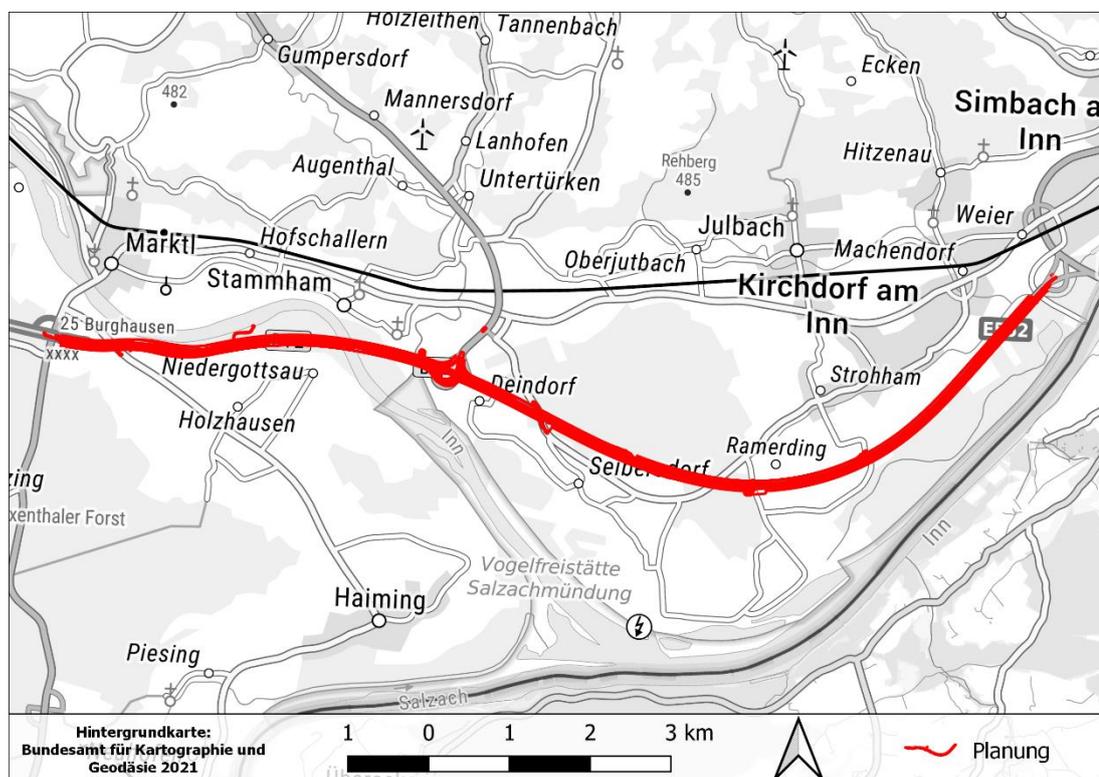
Übersichtslageplan des geplanten Neubaus der A 94
